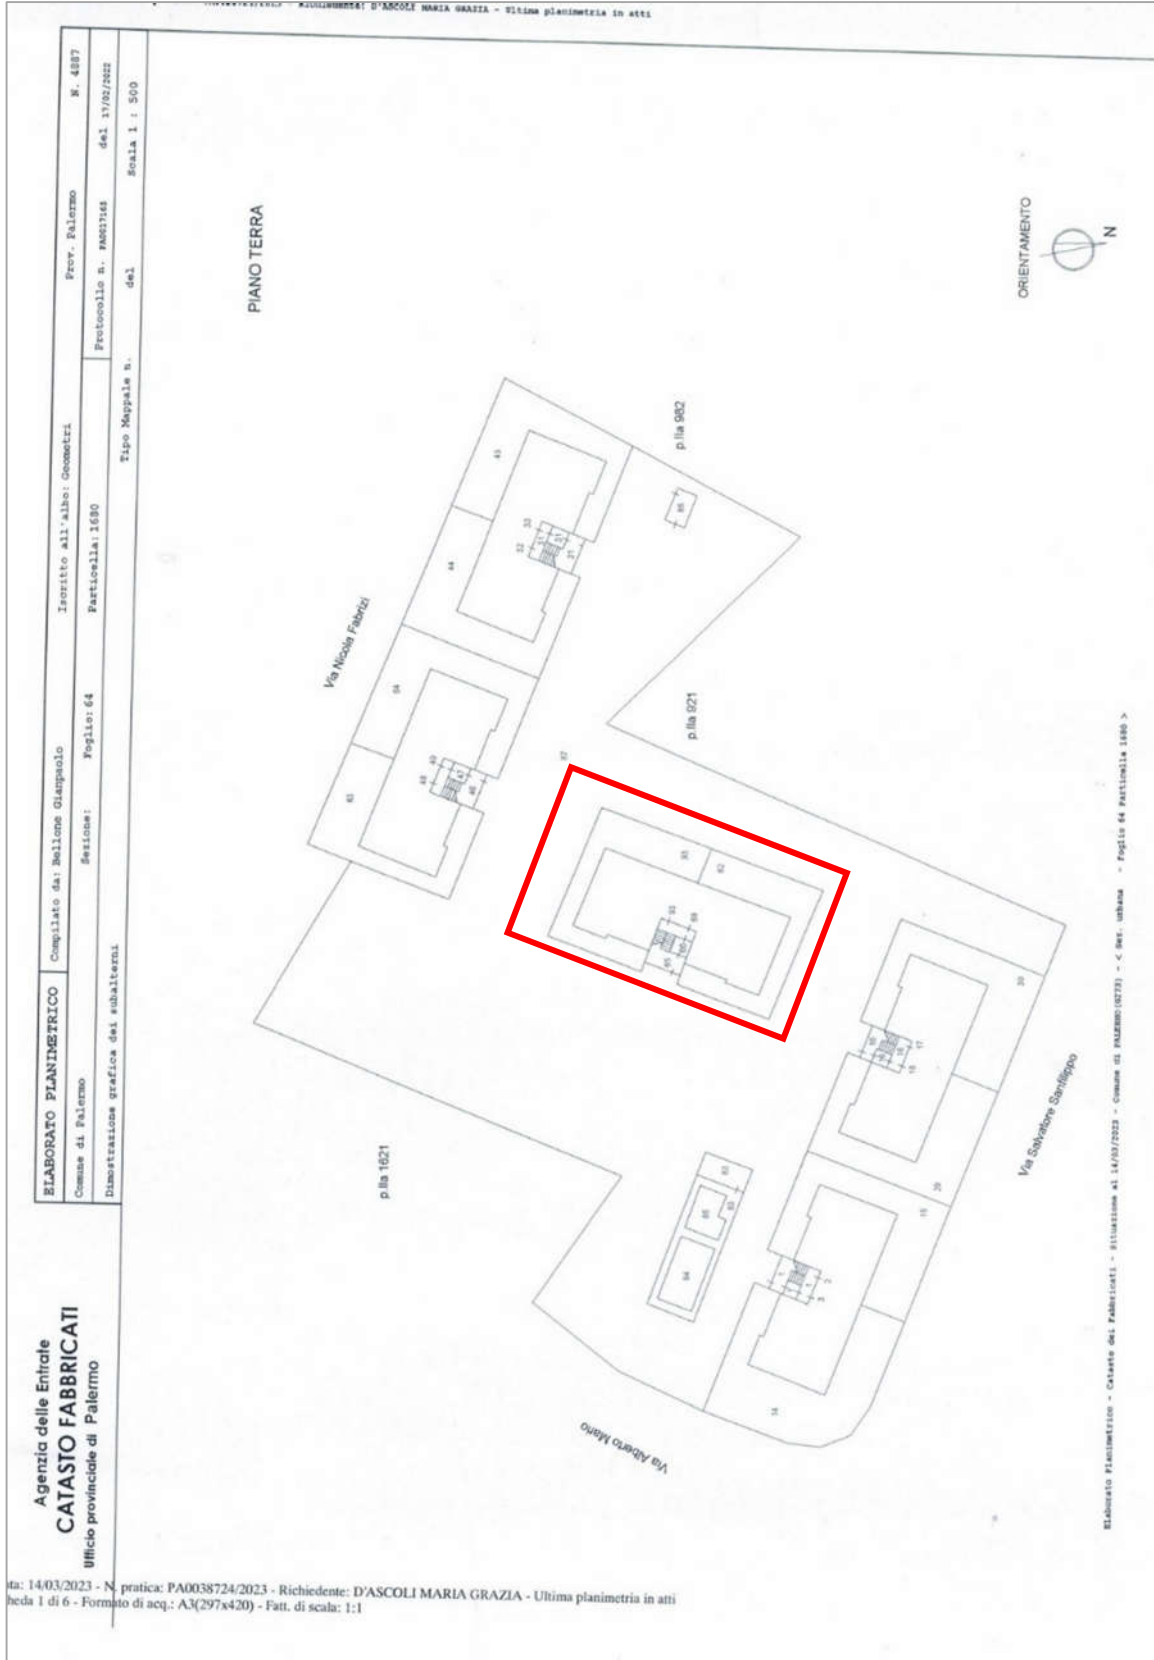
Elaborato planimetrico catastale fg.64 p.la 1680 con indicazione dell'Edificio "H"
